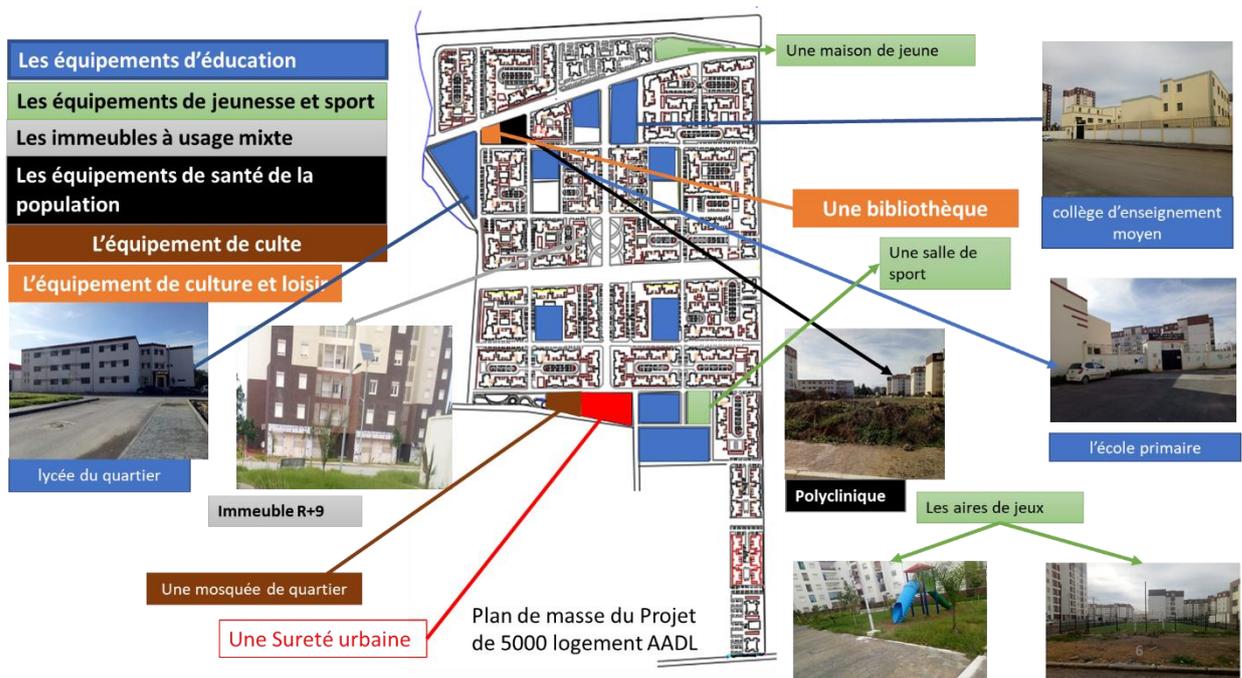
Plan des équipements de projet 5000 logement traité par l'auteur
